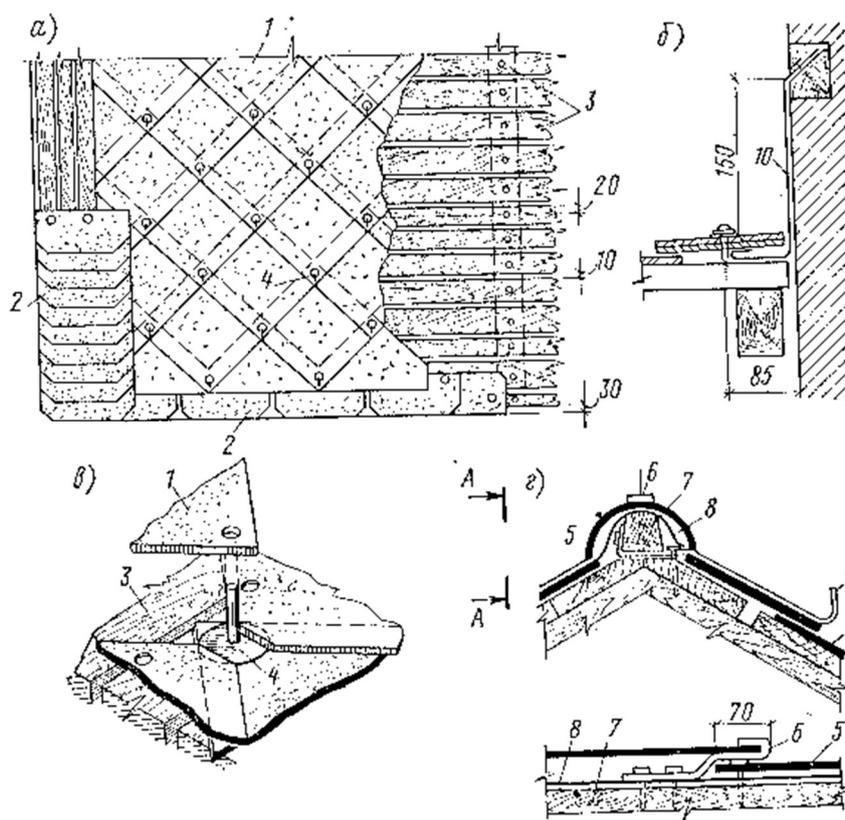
Кровля из плоских асбестоцементных плиток:
